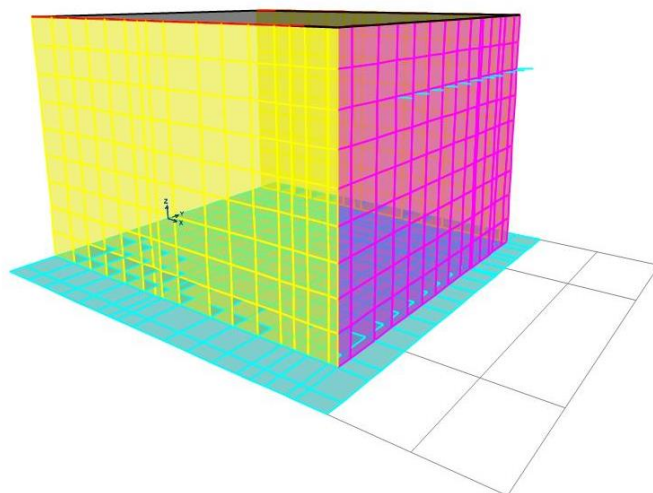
Vista 3D del modello agli elementi finiti della spalla
